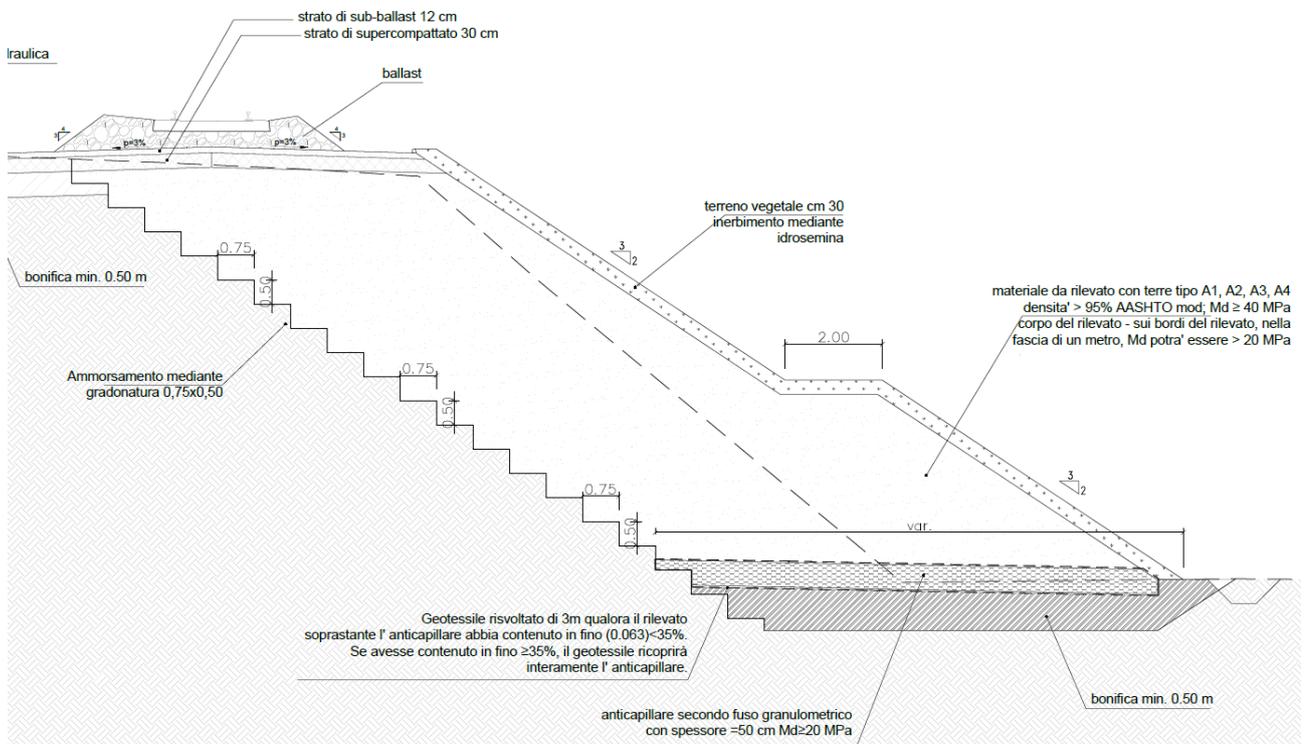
Dettaglio della precedente sezione (riquadro rosso)
